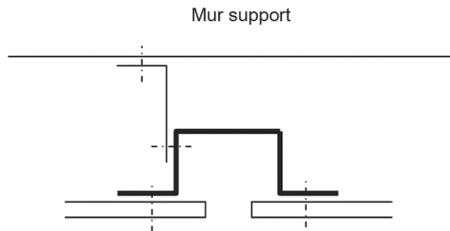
Exemple de coupe horizontale sur ossature verticale drainante
